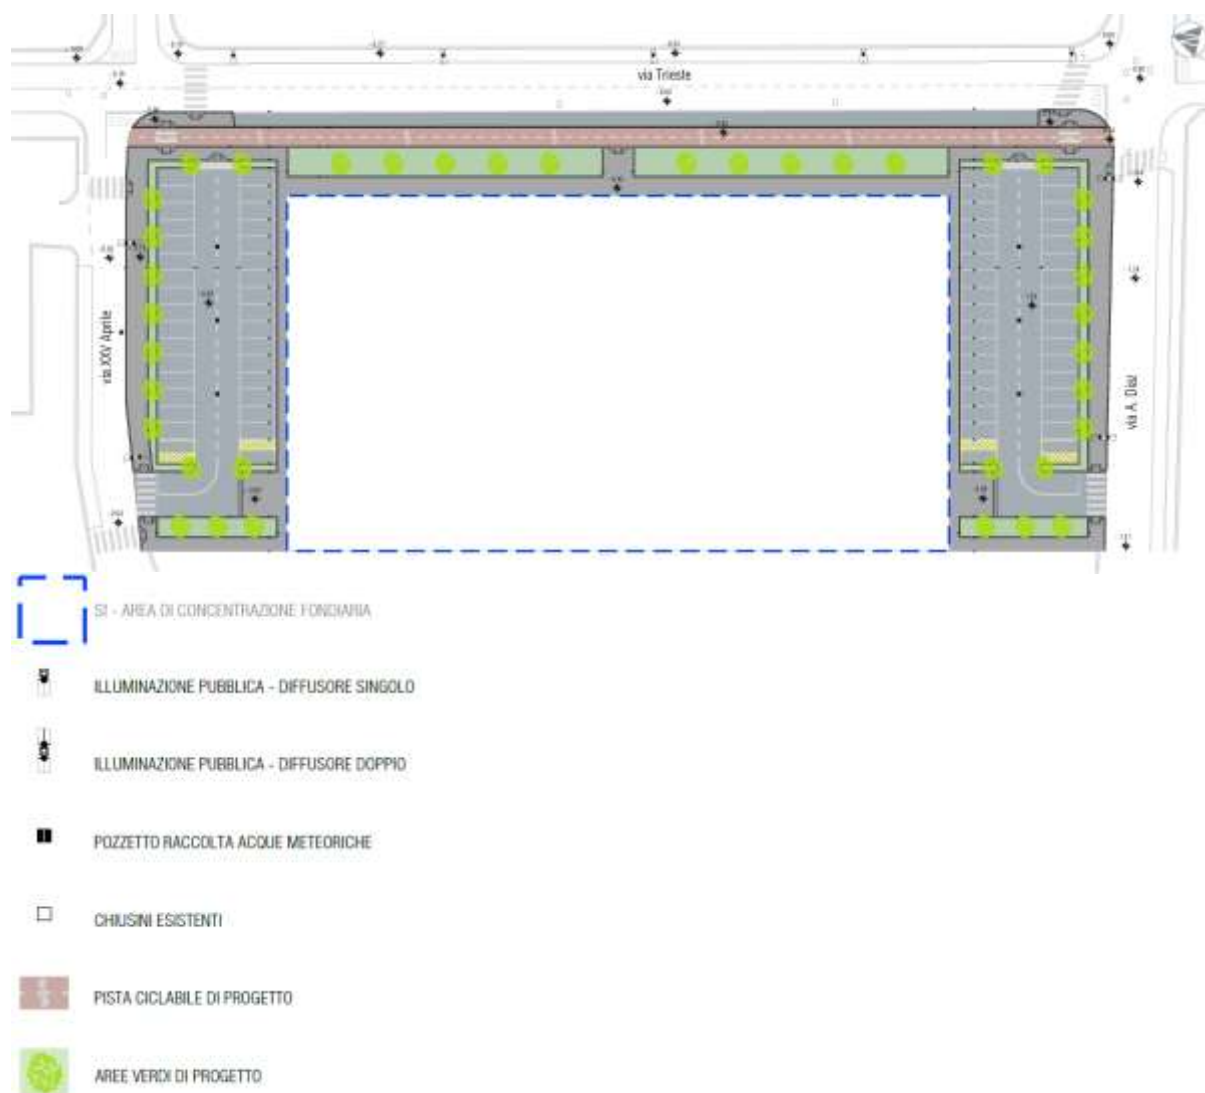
estratto tav. 03.12 planimetria generale opere a scomputo (progetto)
